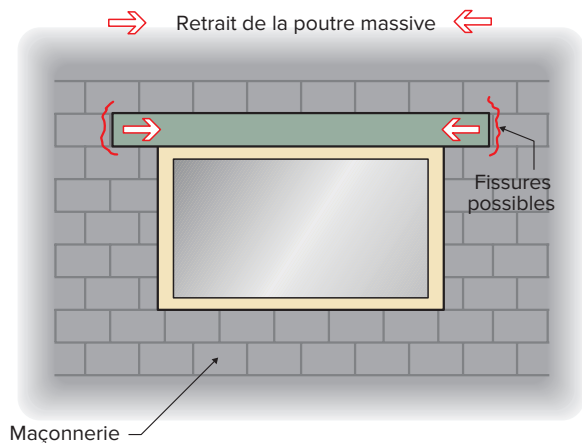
Incorporation d'une poutre massive et longue dans un mur en maçonnerie
